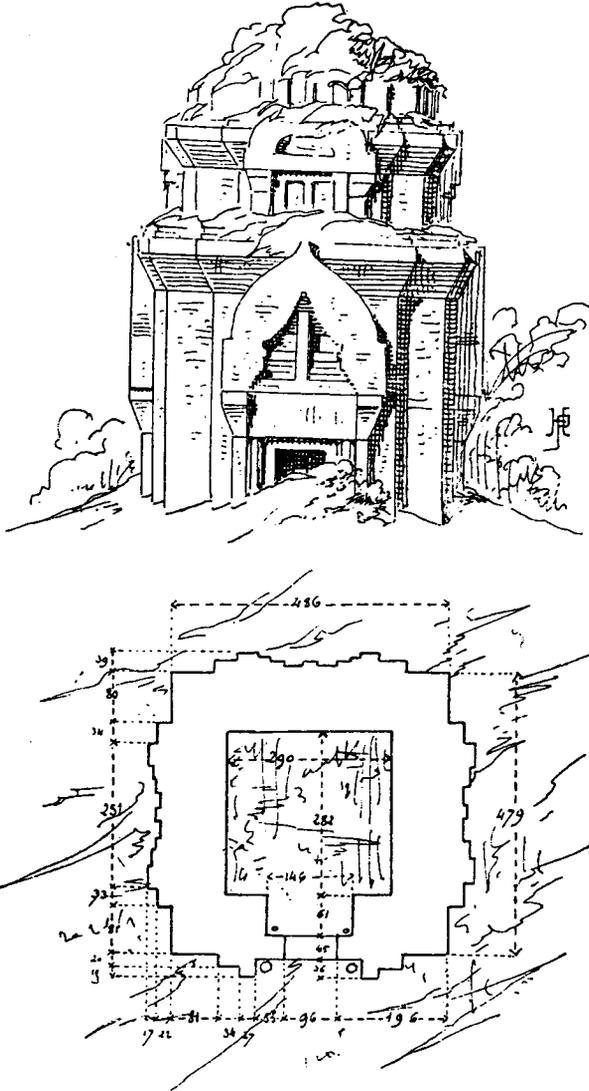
LE PRĀSĀT TRAPĀN KÓN. PLAN ET FAÇADE.
